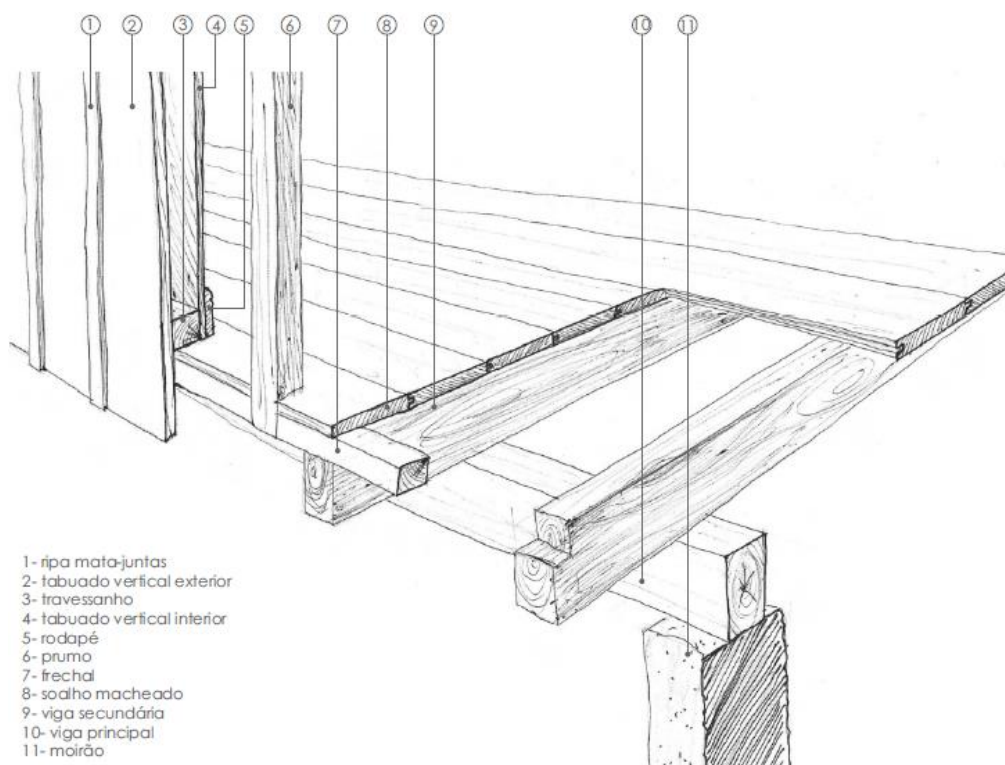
Pormenor tipo do pavimento (fonte: Moutinho (2007))
